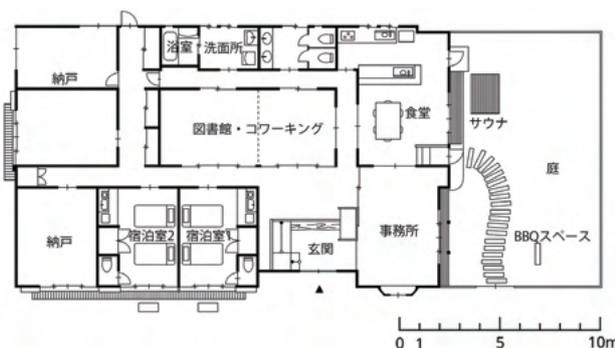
里山ゲストハウス晴耕雨読とみだ 平面図
